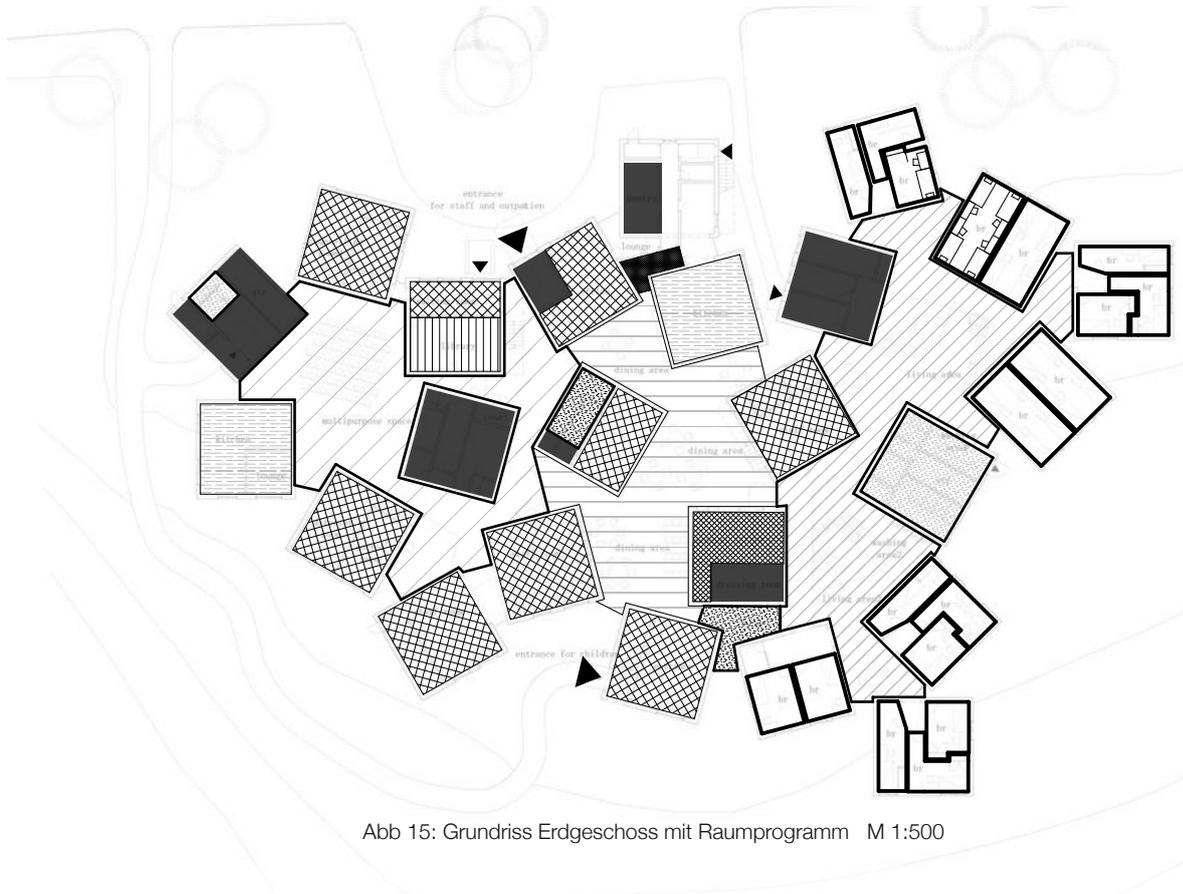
Grundriss Erdgeschoss mit Raumprogramm M 1:500
